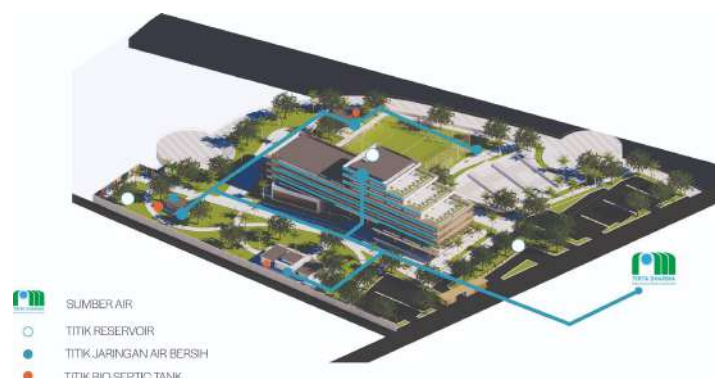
Isometri sistem sirkulasi dalam bangunan
